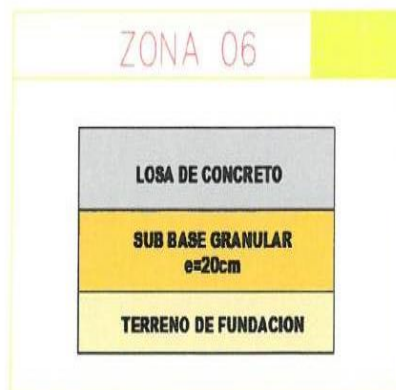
Sección recomendada de pavimento ZONA 06. Fuente: Elaboración Propia
